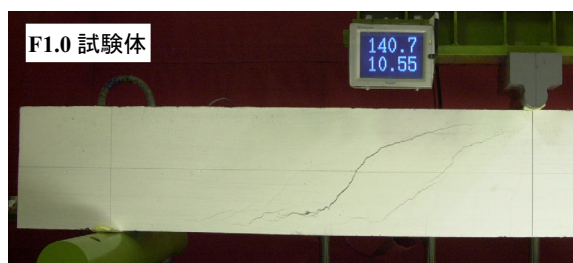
剛性低下後におけるひび割れ状況
